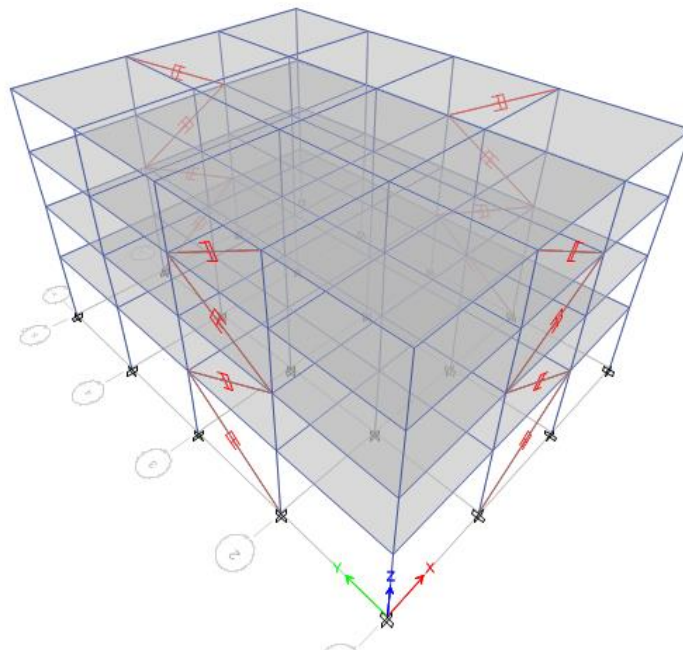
Vista tridimensional de la disposición diagonal
